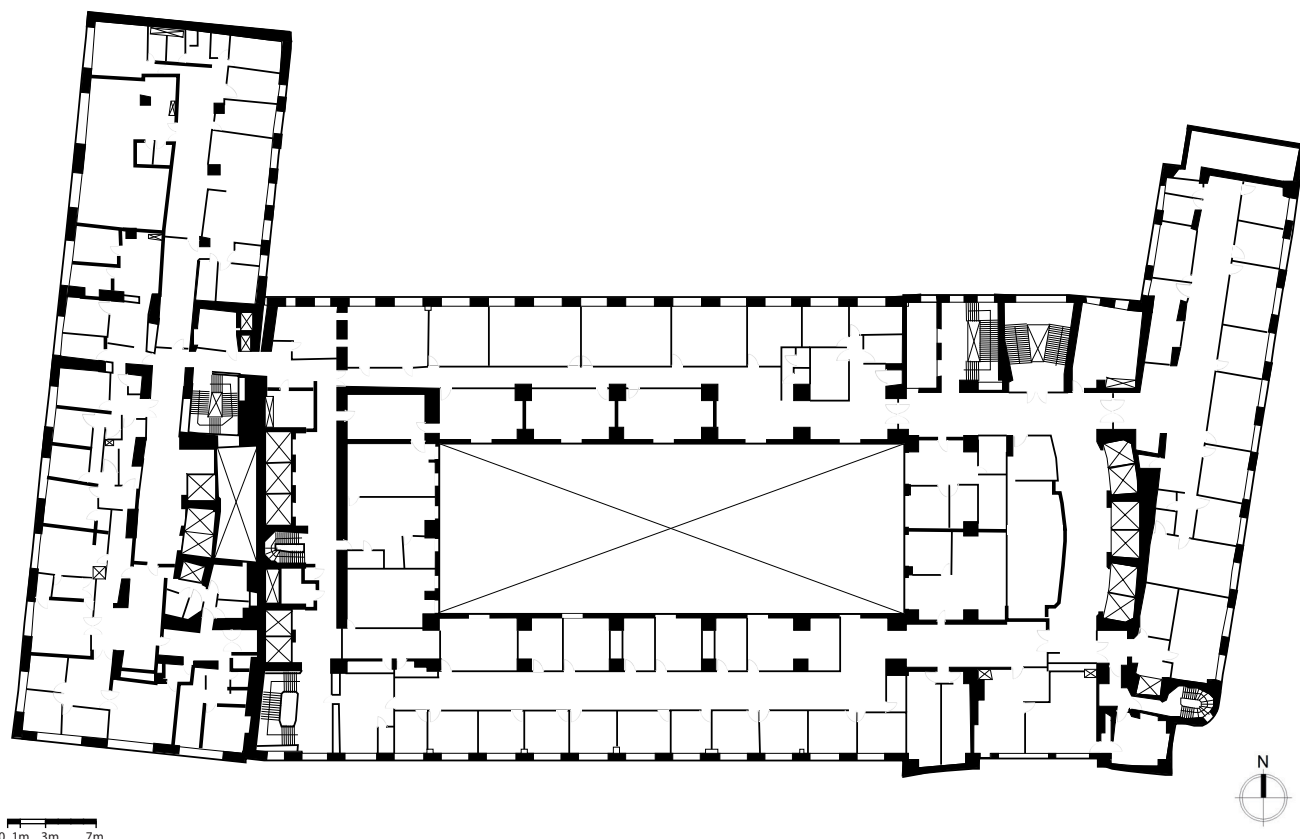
Planimetría original del edificio. Fuente de: Elaboración propia.
